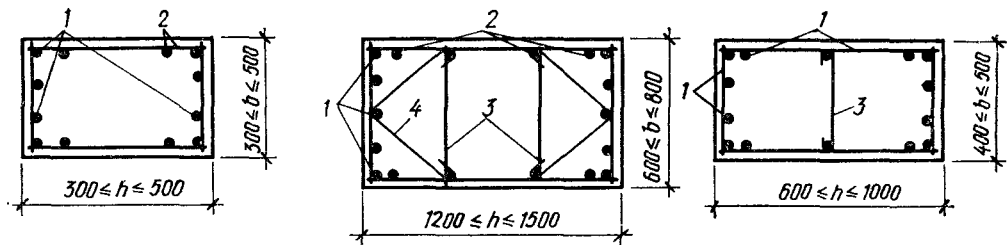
Примеры армирования сечений колонн с рекомендуемым количеством стержней сварными сетками:
